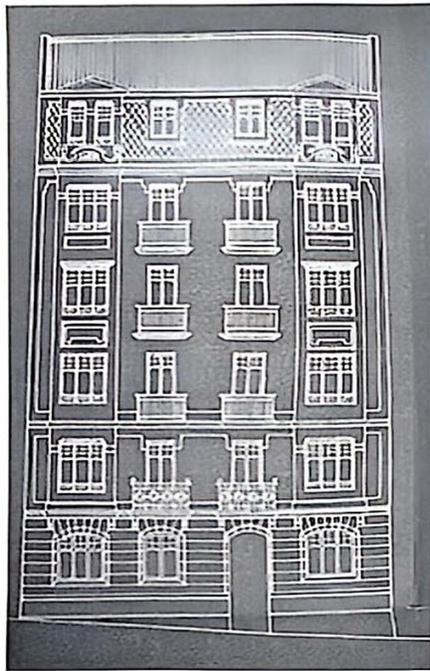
Plano de la fachada de la casa número 50 de la calle Iturribide. 1928. Arquitecto Julio Sáenz de Baräs.
